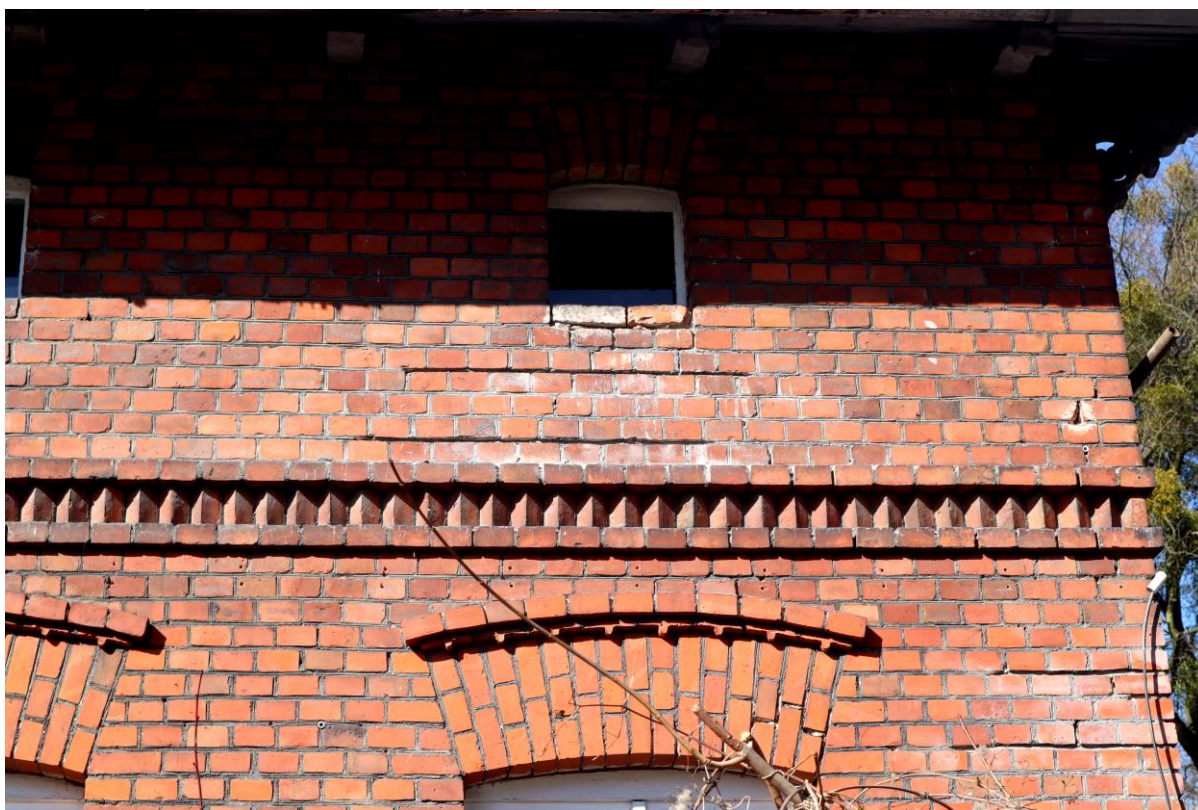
Dom walmistrza , elewacja północna po oczyszczeniu
